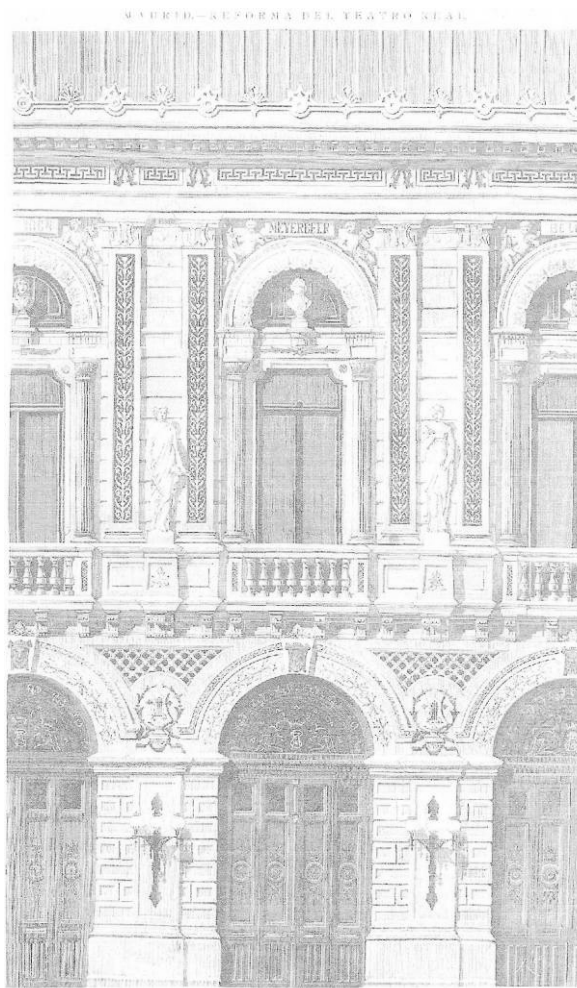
“MADRID. REFORMA DEL TEATRO REAL. LA NUEVA FACHADA PRINCIPAL EN CONSTRUCCIÓN.- (Proyecto del arquitecto D. Joaquín de la Concha Alcalde)
